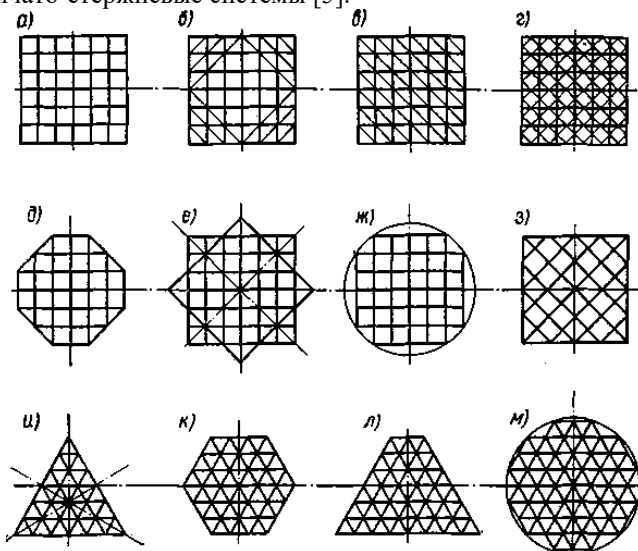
Основные схемы покрытий из вертикальных перекрестных балок и ферм
